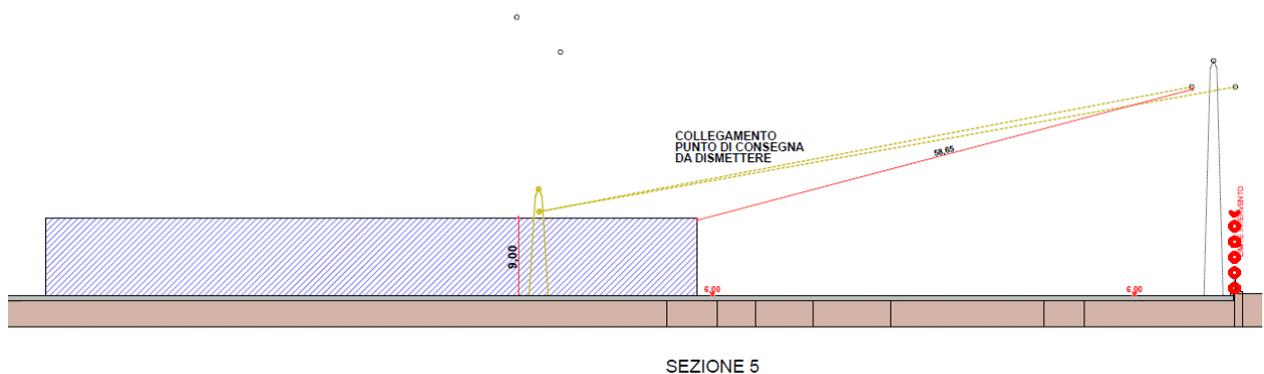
Sezione stato attuale e futuro linea elettrica e fabbricato Termomeccanica
